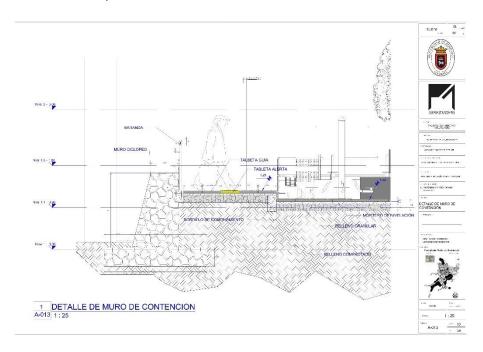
Detalle arquitectonico de muro de contención.
